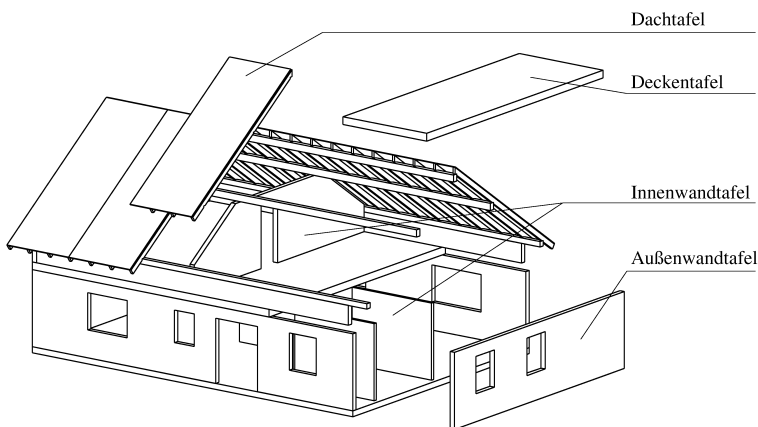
Aufbau eines eingeschossiges Gebäudes in Holztafelbauart
